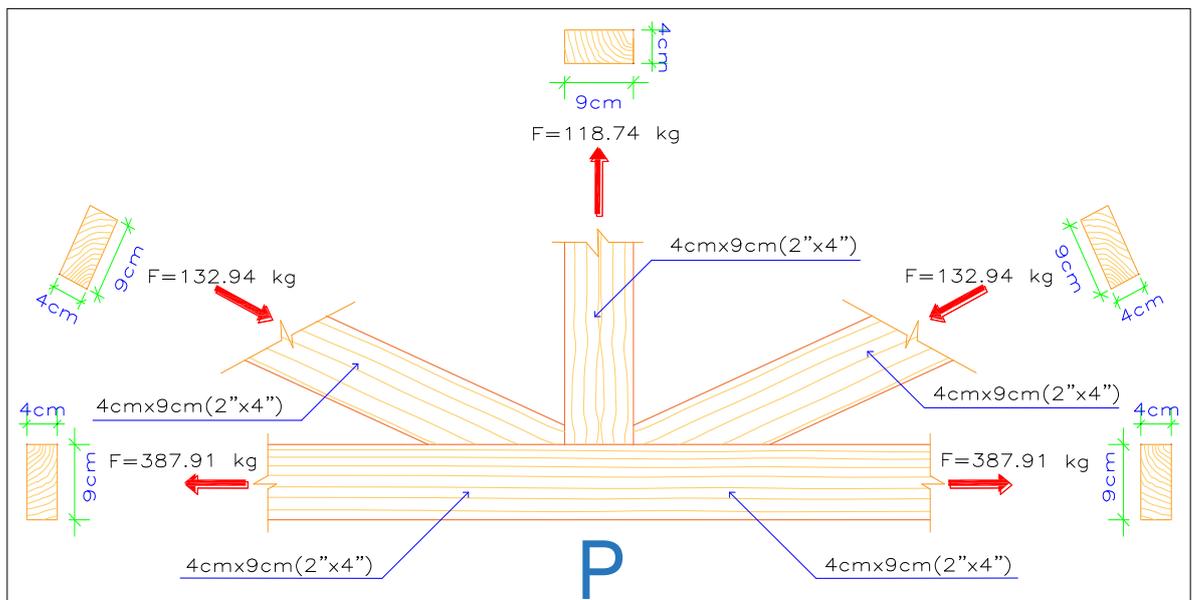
Nudo "P" de la armadura tipo montante maestro
